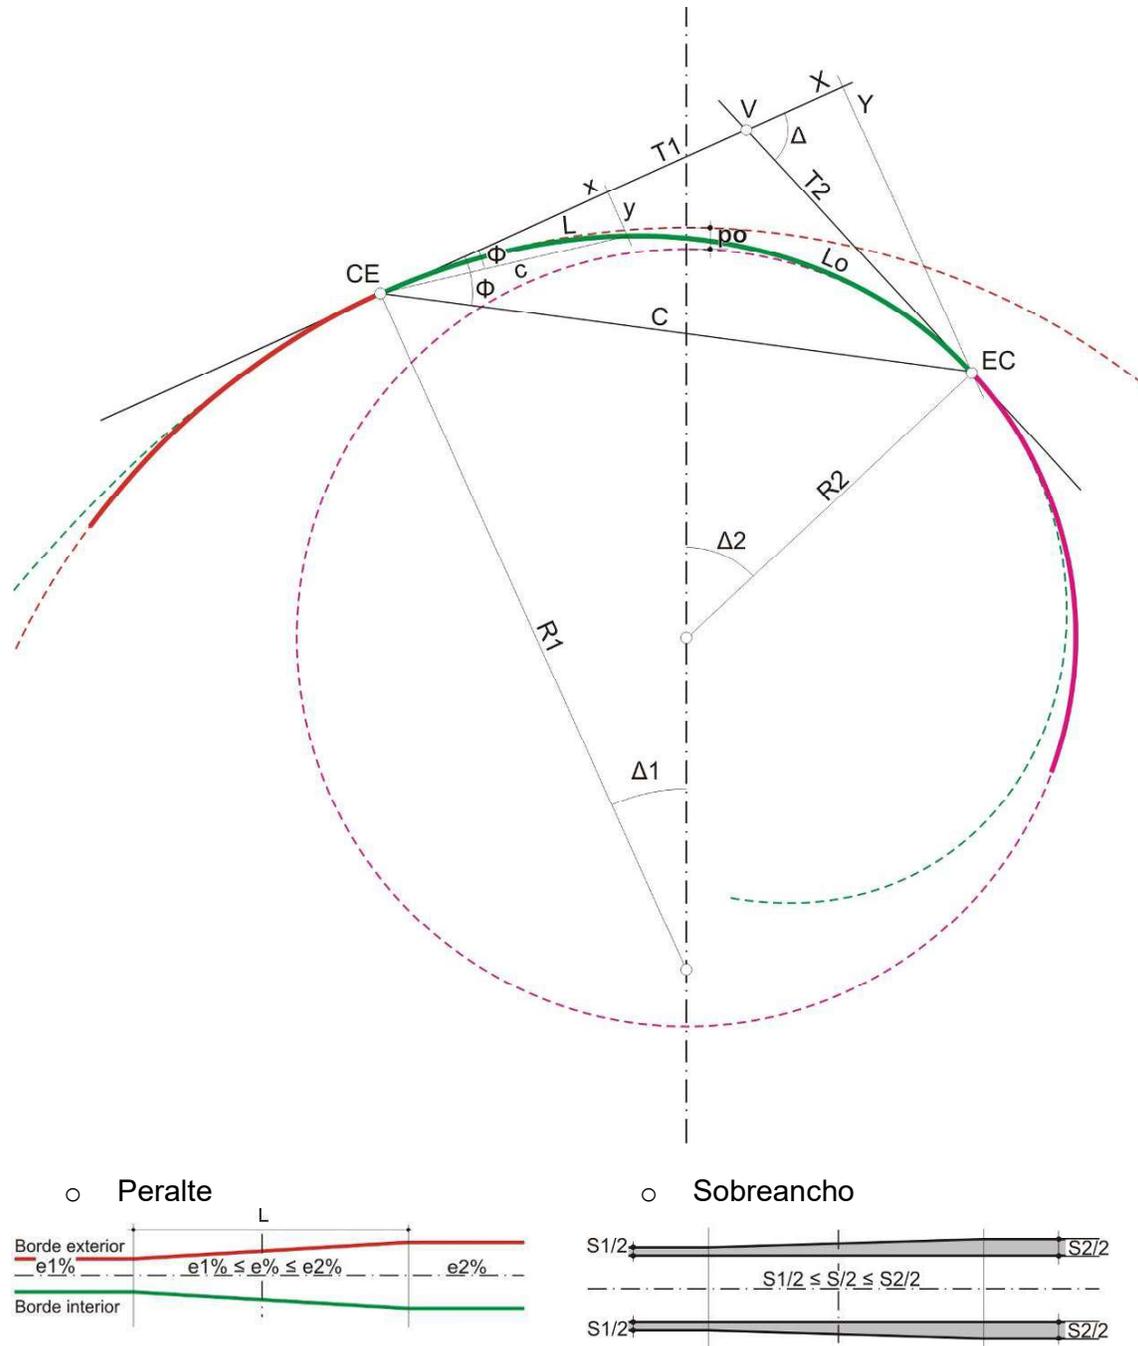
Planimetría, peralte y sobrecancho de la ovoide
